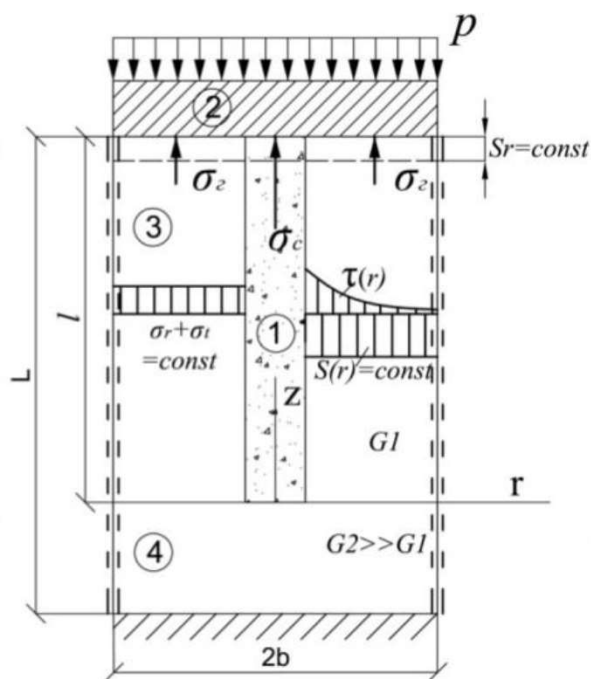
Расчетная схема взаимодействия сваи с грунтовым массивом и ростверком по схеме сваи стойки. На рисунке: свая-1; ростверка-2; окружающий грунт-3; подстилающий грунт-4 [3]
